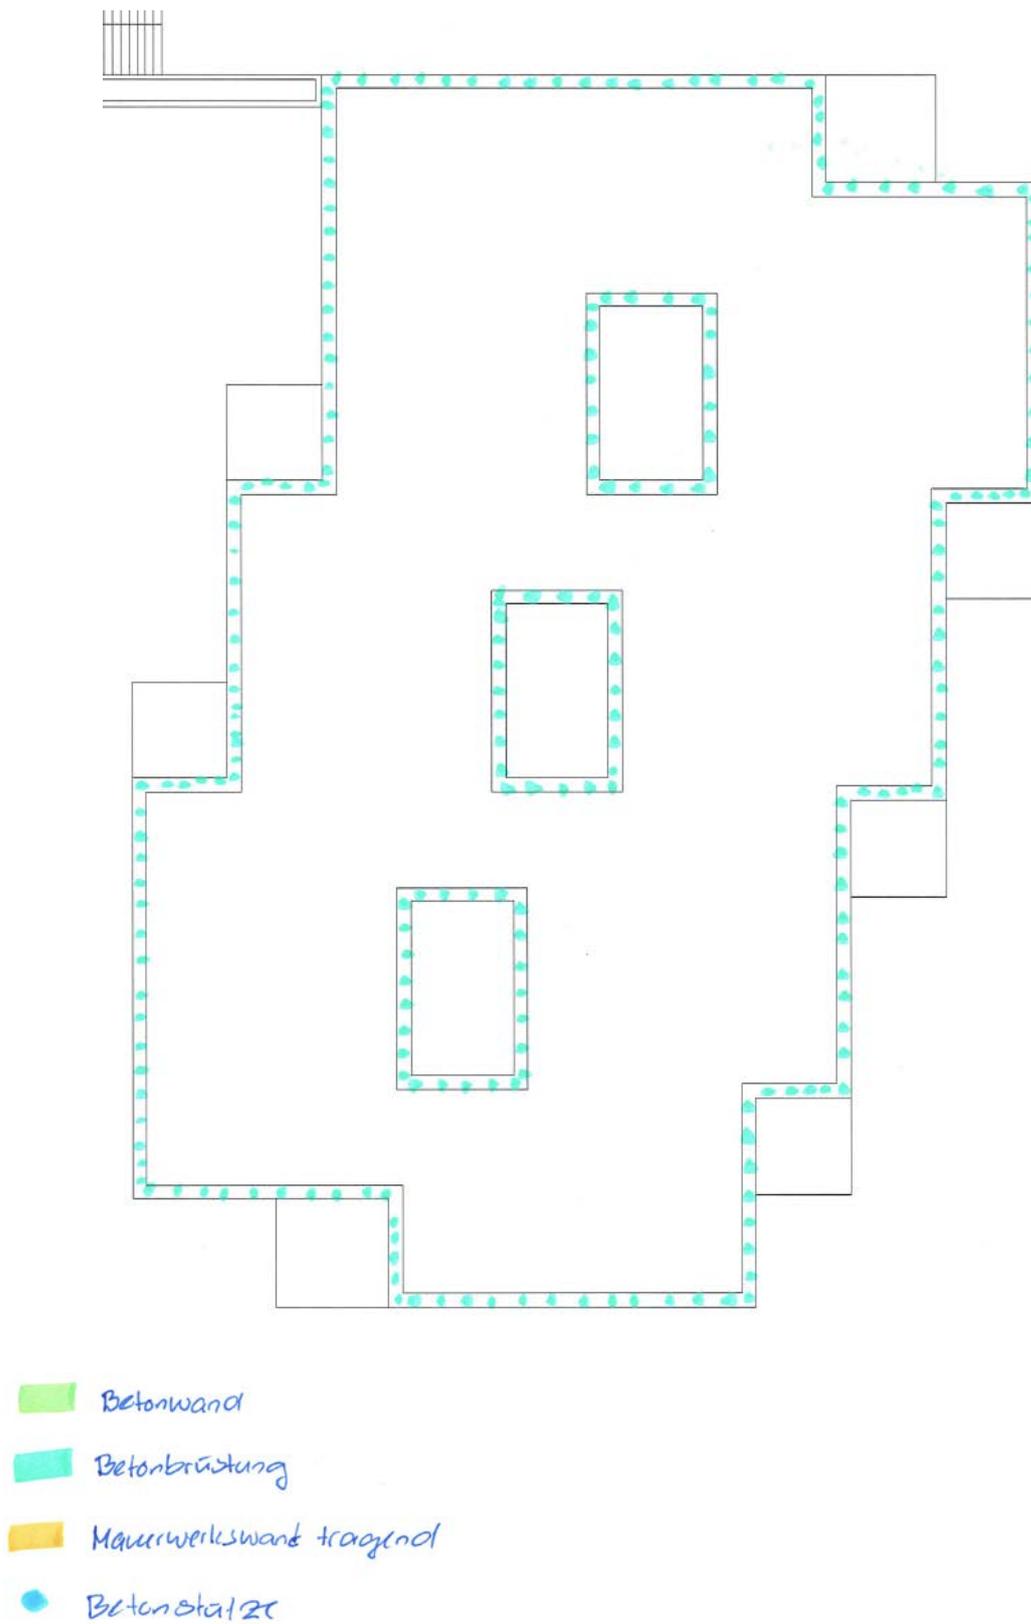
Tragstruktur Neubau OG02 (=Dachaufsicht)
